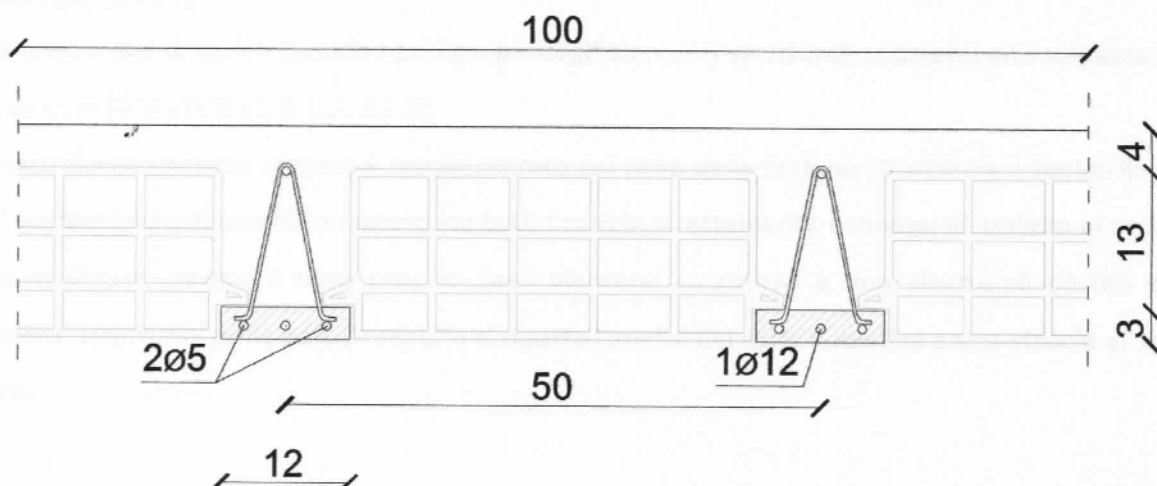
Solaio in latero-cemento con travetto prefabbricato in traliccio metallico
